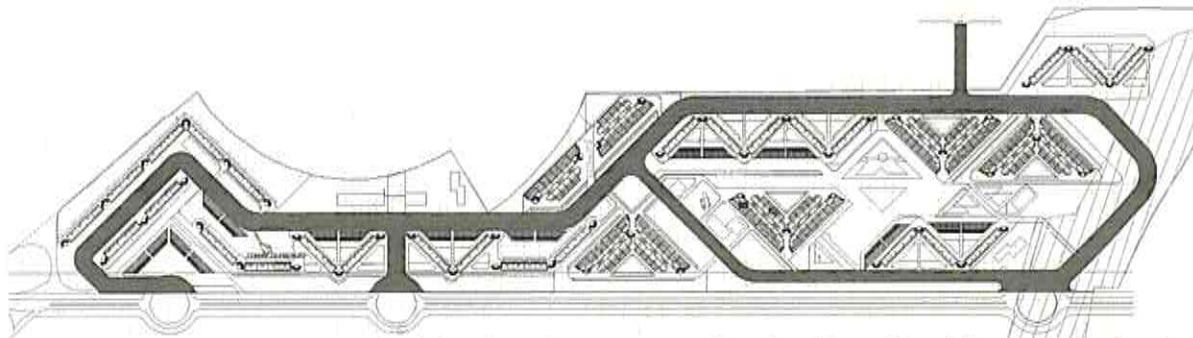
Planimetria del Piano Particolareggiato vigente, con evidenziato il tracciato della viabilità primaria.
